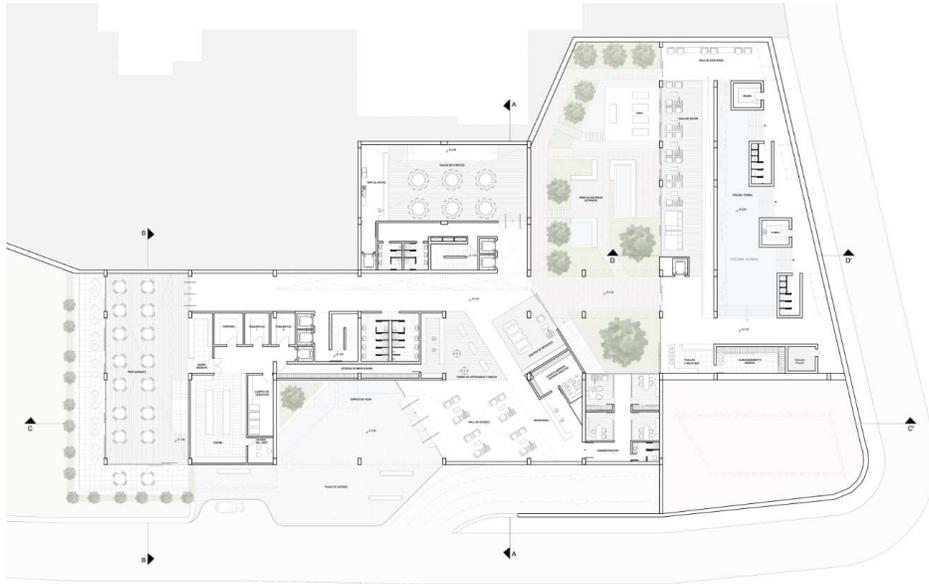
Planta Baja Ingreso Principal Vehicular- Calle Ninahualpa. \otimes N – 7,20 m
